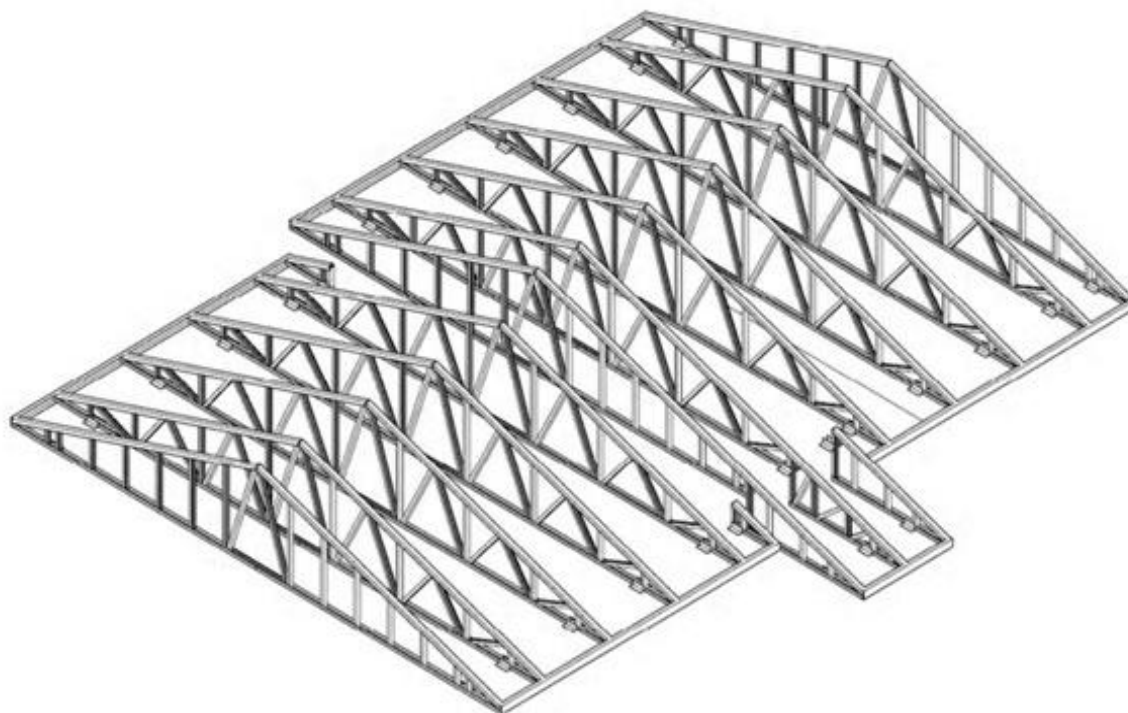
Общий вид стропильных конструкций из ферм треугольного очертания
